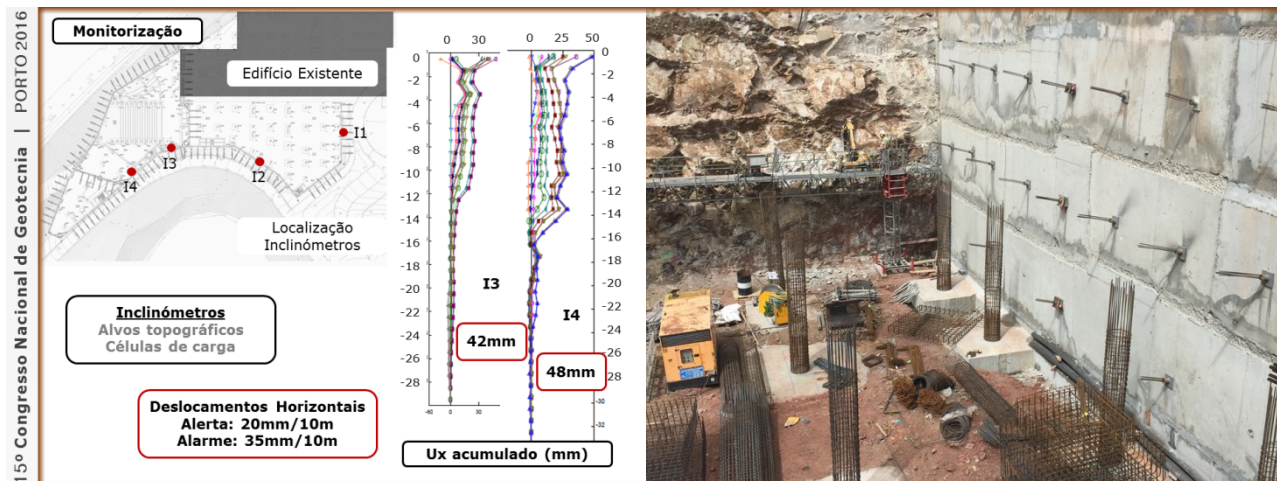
Localização dos inclinómetros e leituras acumuladas na última campanha de leitura (à esquerda) e Imagem da face interior da contenção na zona do inclinómetro I1 (à direita).
